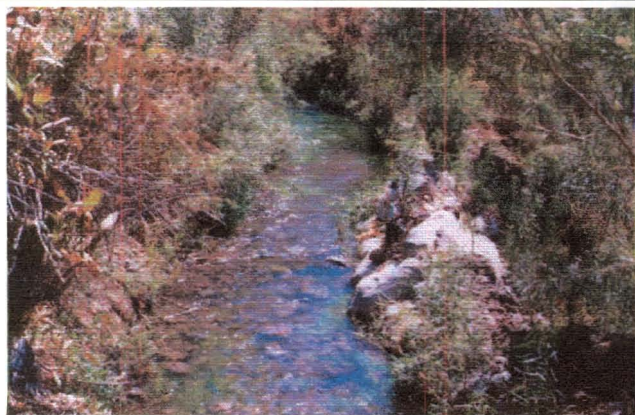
Borde destruido. El borde fue reconstruido con sacos, piedras y tierra.
